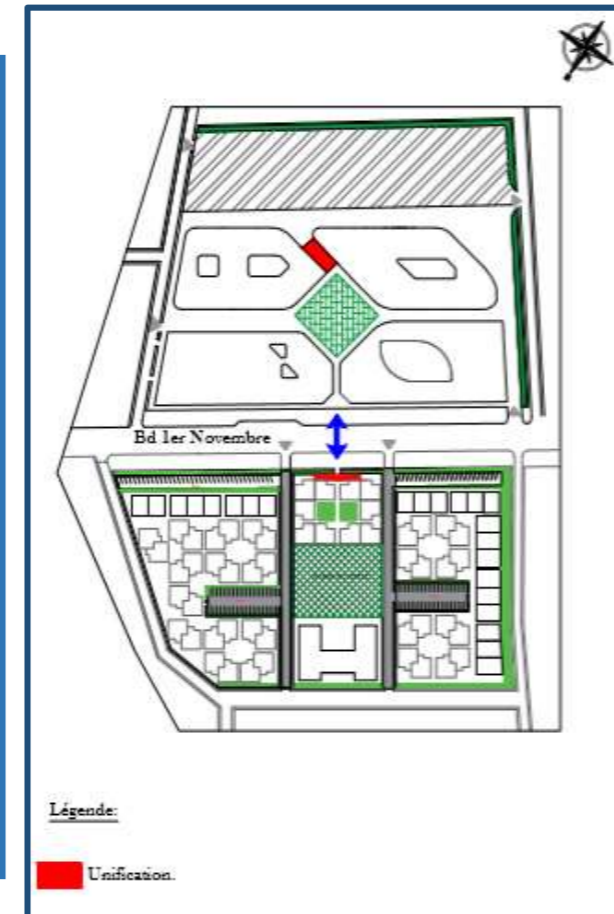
Etape 4 – Genèse du Plan d'aménagement.
